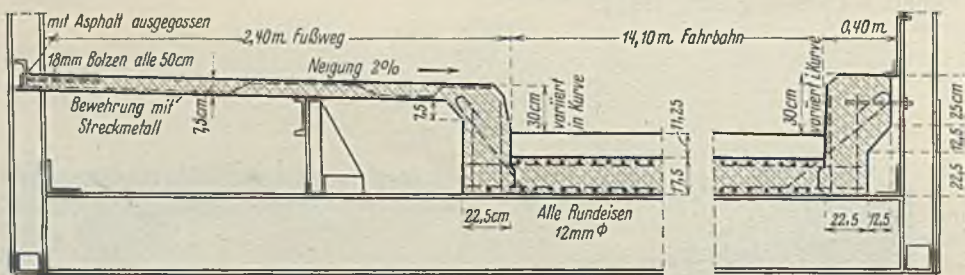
Querschnitt durch Fahrbahn- und Fußwegdecke der Zufahrtrampen.
